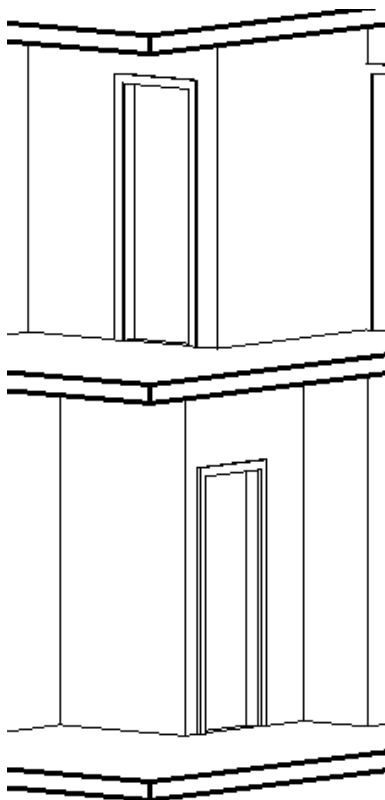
Pilar que nasce sobre viga devido a projeção da laje
